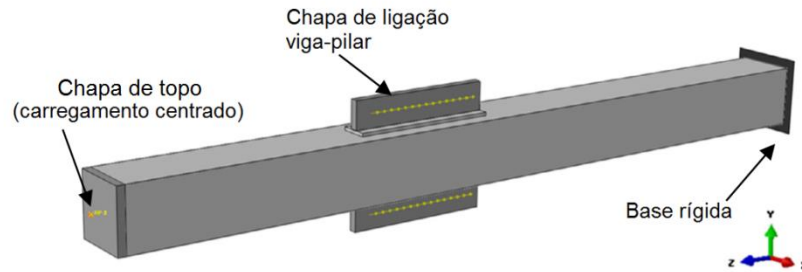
Modelo numérico de pilar com chapa de topo e chapas de ligação entre viga e pilar (Mollazadeh e Wang, 2015).
